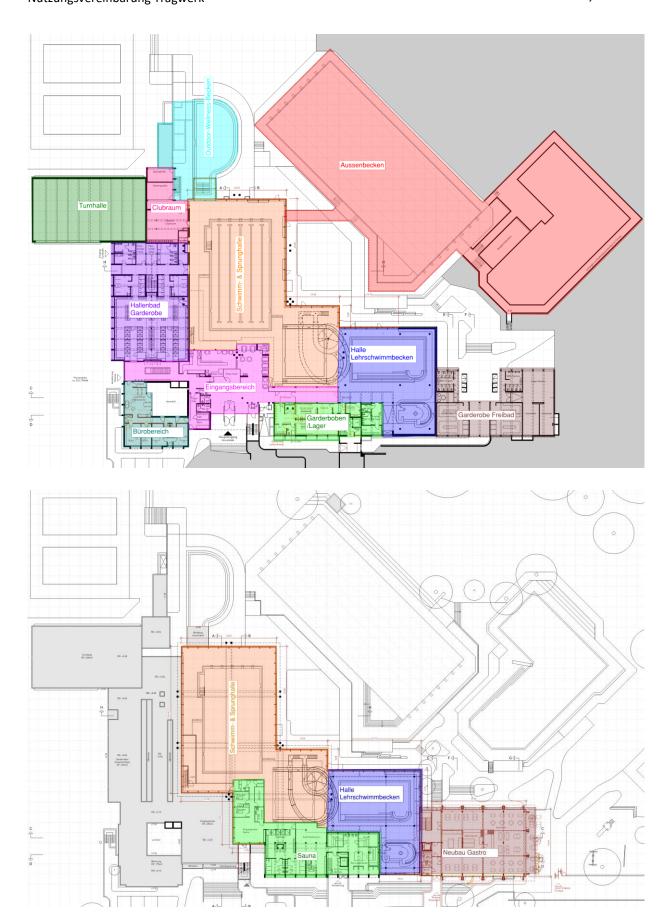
Grundriss Erdgeschoss (oben) und Grundriss Obergeschoss (unten) (Verkleinerungen).
